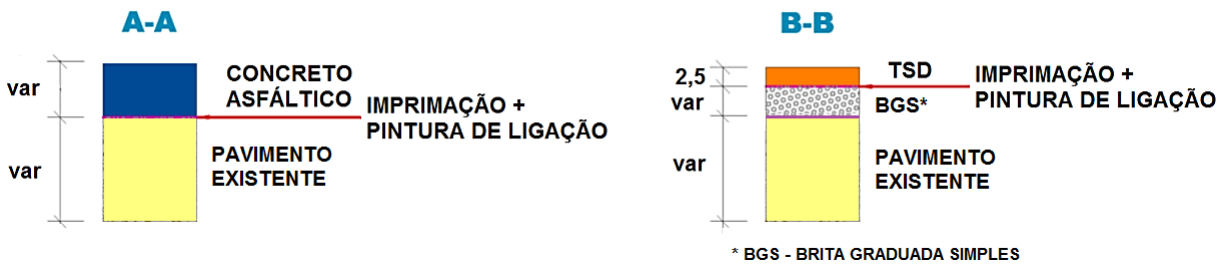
Seções transversais A-A e B-B demonstrando a composição das camadas (restaurações)
